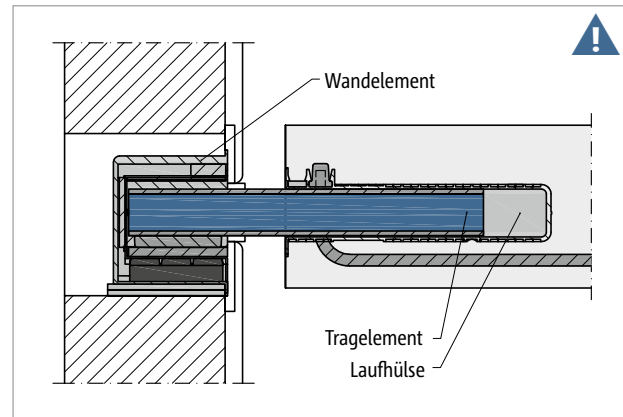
Schöck Tronsole® Typ Q: Mehrteiliges Produkt (Wandelement, Tragelement, Laufhülse); Tragelement (eingefärbt) muss auf der Baustelle eingebaut werden.
